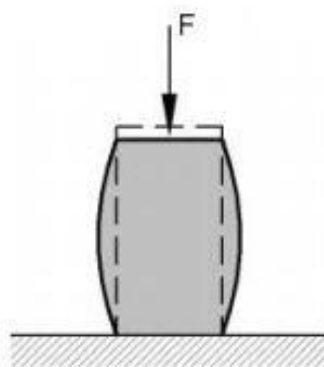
Exemplo da deformação do pilar (Figueira, 2016)
